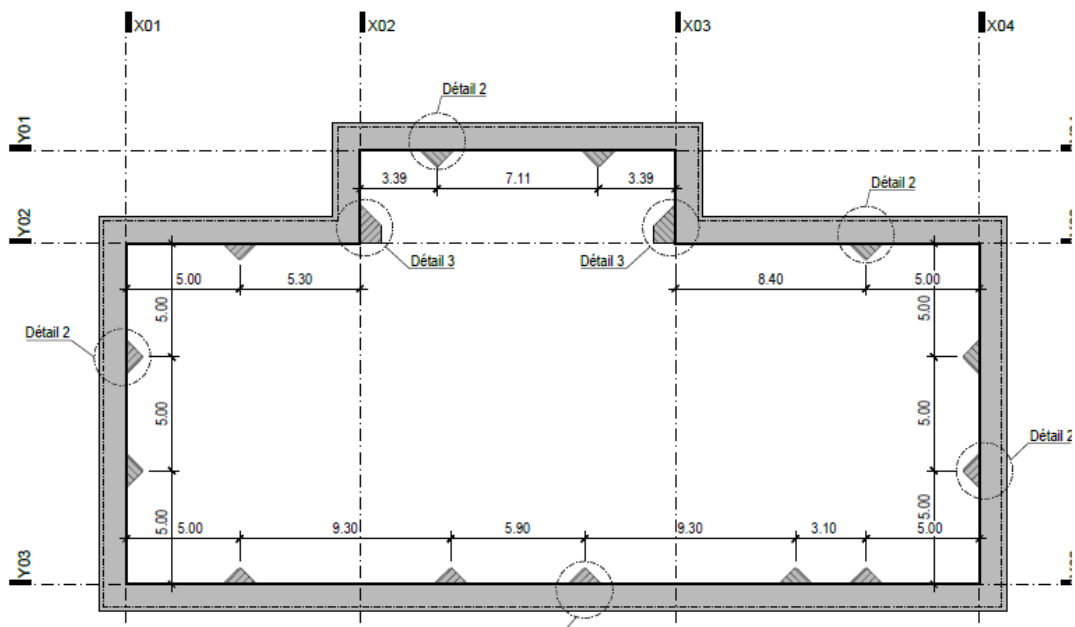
Vue en Plan Au Niveau +10.20 (Poutre 2 Et Massifs D'appui)
